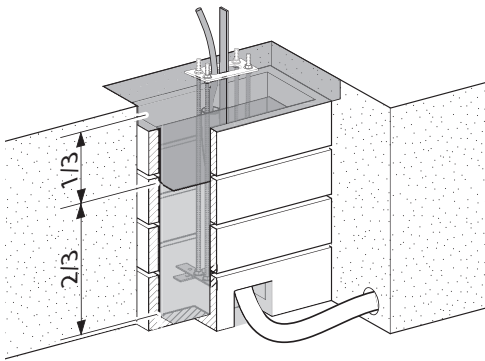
Cementazione delle fondazioni (esempio: AMEDIO)
